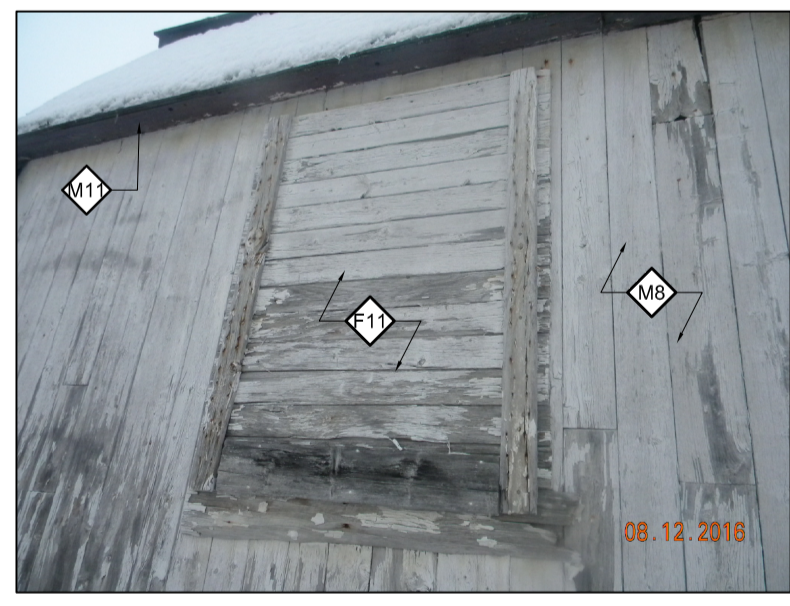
REVÊTEMENT EN PLANCHES HORIZONTALES À RÉMONTOR.
